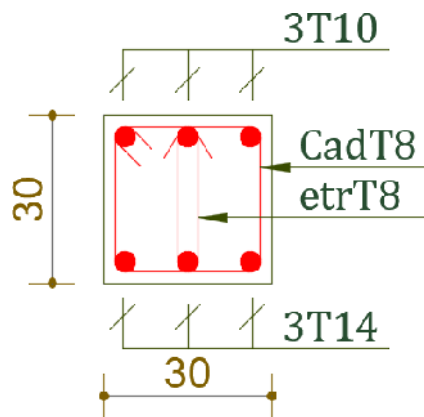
Détail de ferrailage de la poutre de chaînage
